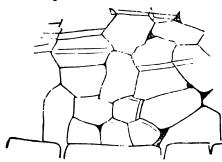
Chaussée dallée d'une rue de Pompéi.
